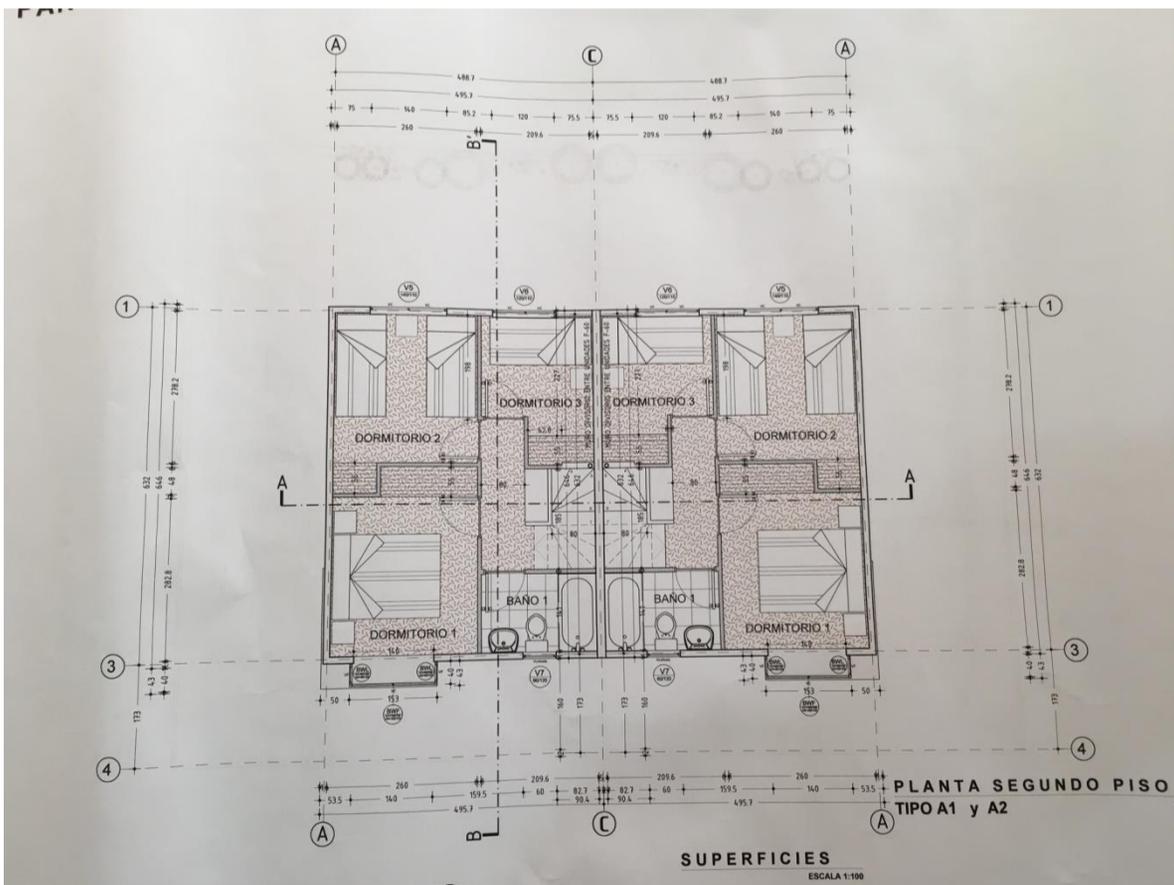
Planta Segundo piso casa tipo A1 y A2.
